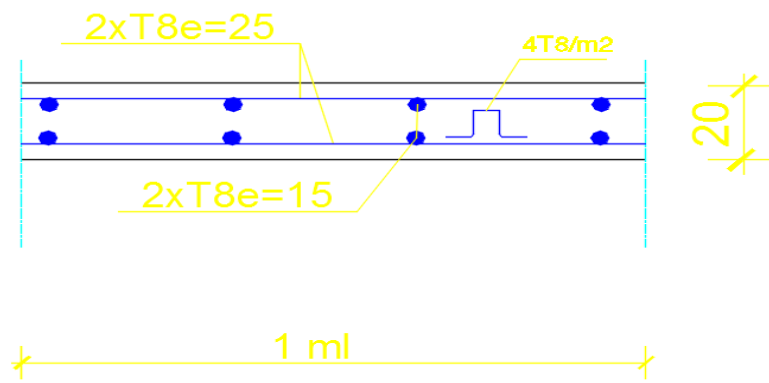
Schéma de ferrailage d'une bande de 1m de la dalle pleine
